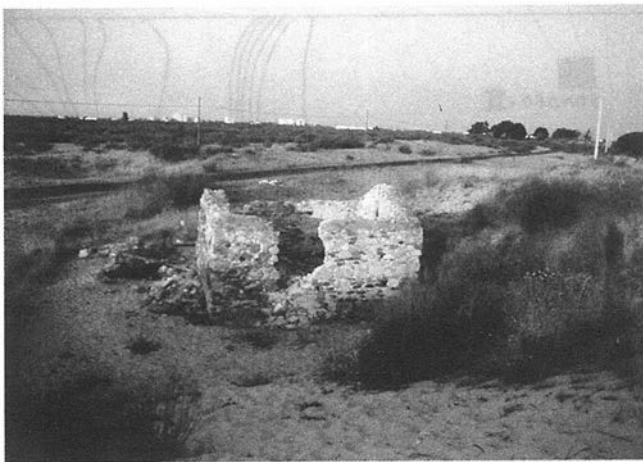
Fachada E. Puerta tapiada y escombros.
